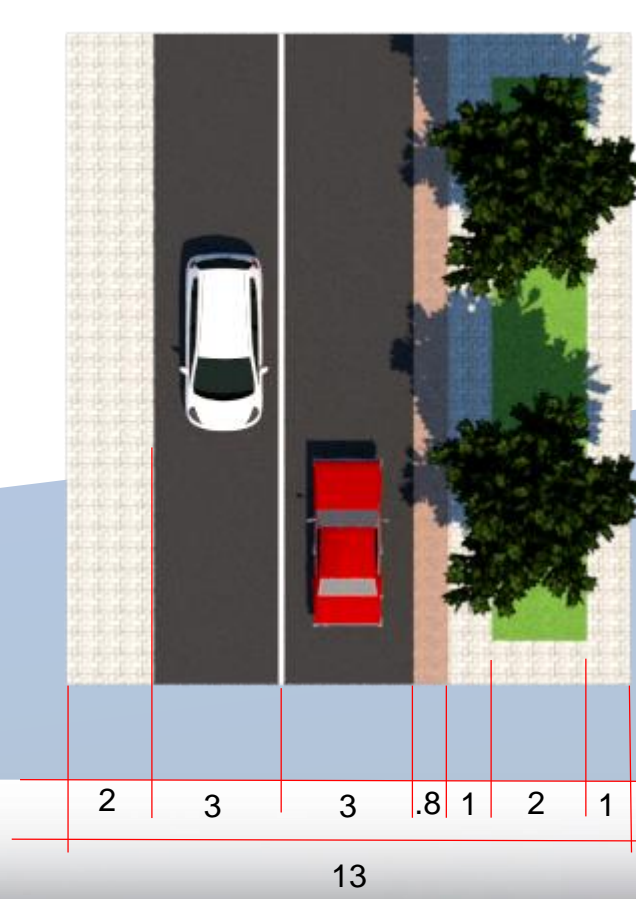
e 49 – Planta e Perspectiva. Fonte: Autor.
